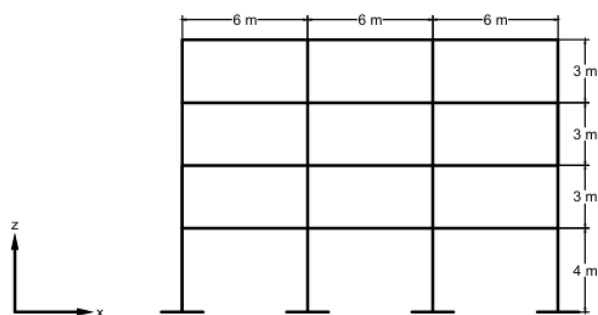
Vista em alçado do sistema estrutural do edifício de 4 pisos
